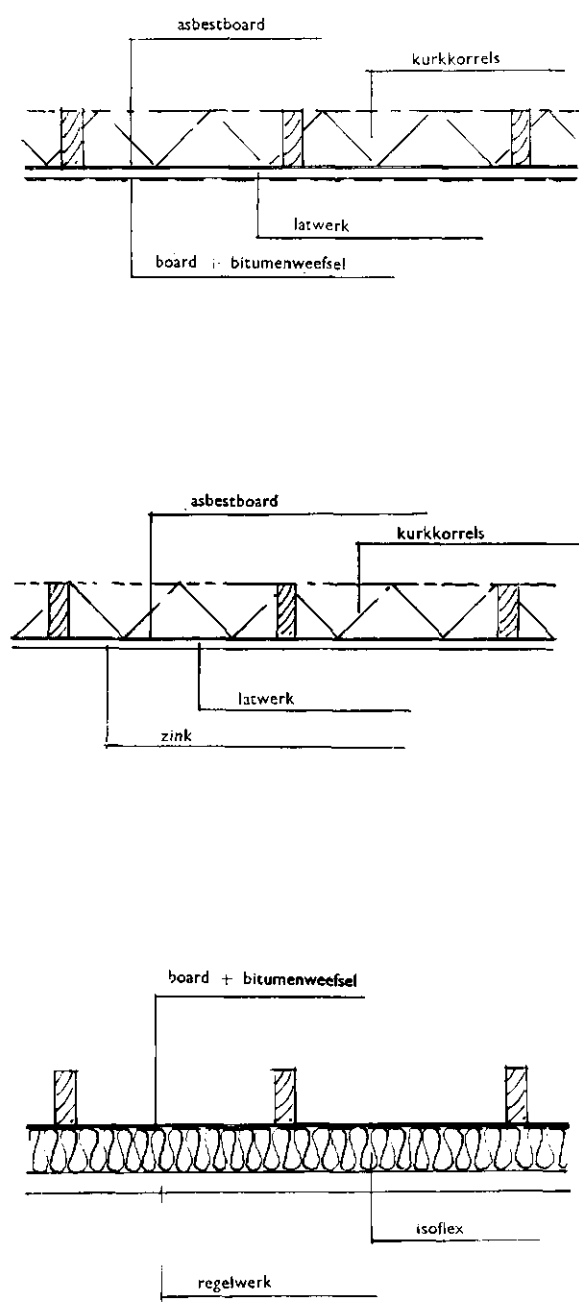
Enkele constructiemogelijkheden voor geïsoleerde plafonds.
